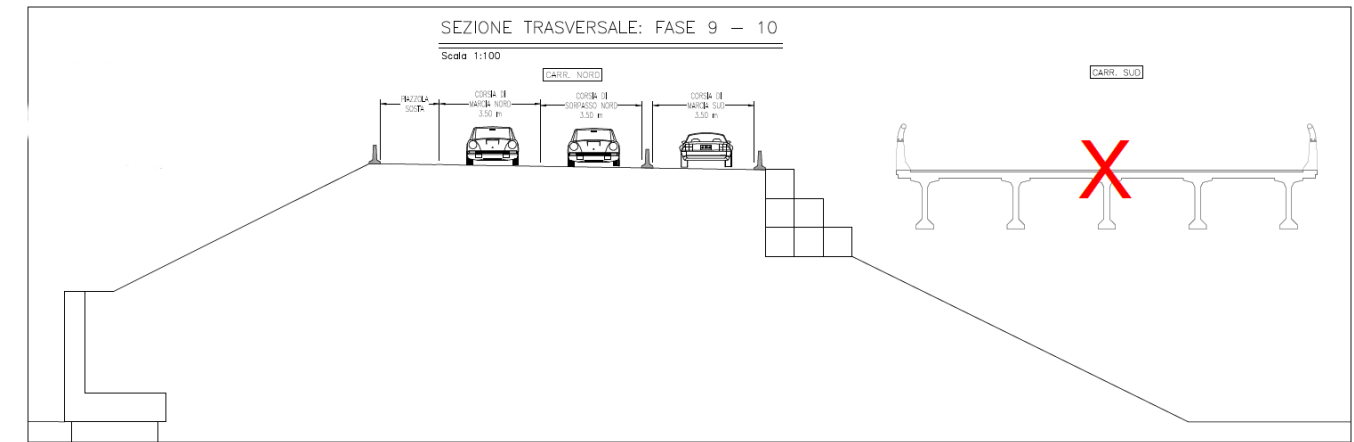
Sezione trasversale: Fasi 9 e 10
